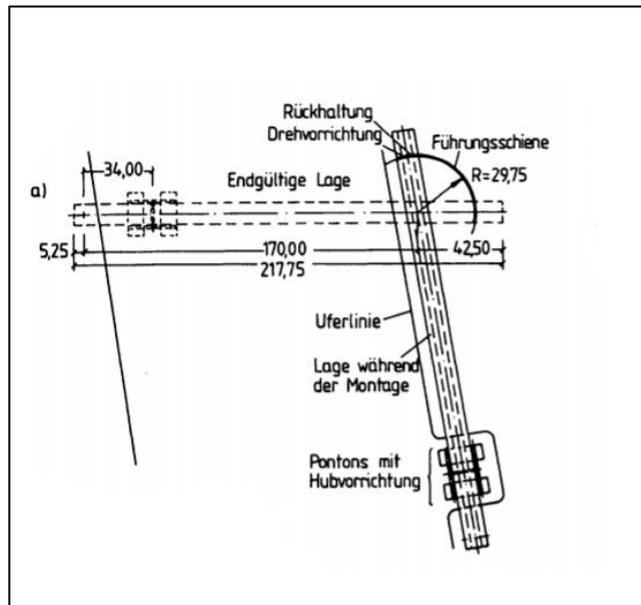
planta pasarela de la Cartuja, Sevilla [3]
